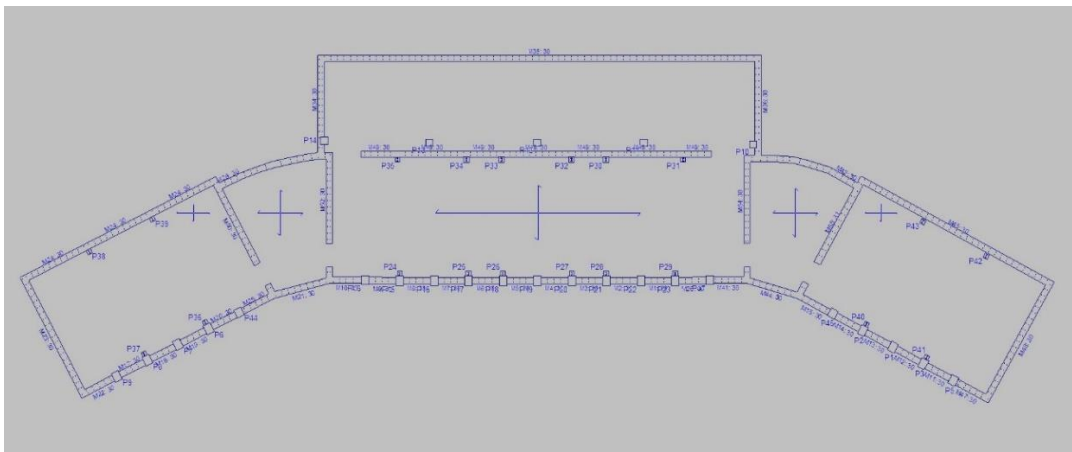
Planta 1 del modelo de 5 plantas simplificado
